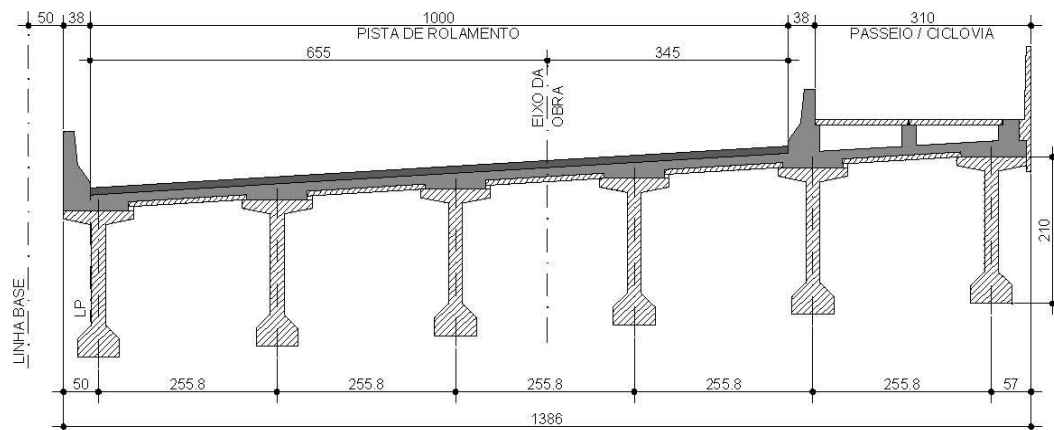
Seção transversal típica (unid: cm): tabuleiro de largura 13,86m e vão de 40m.
